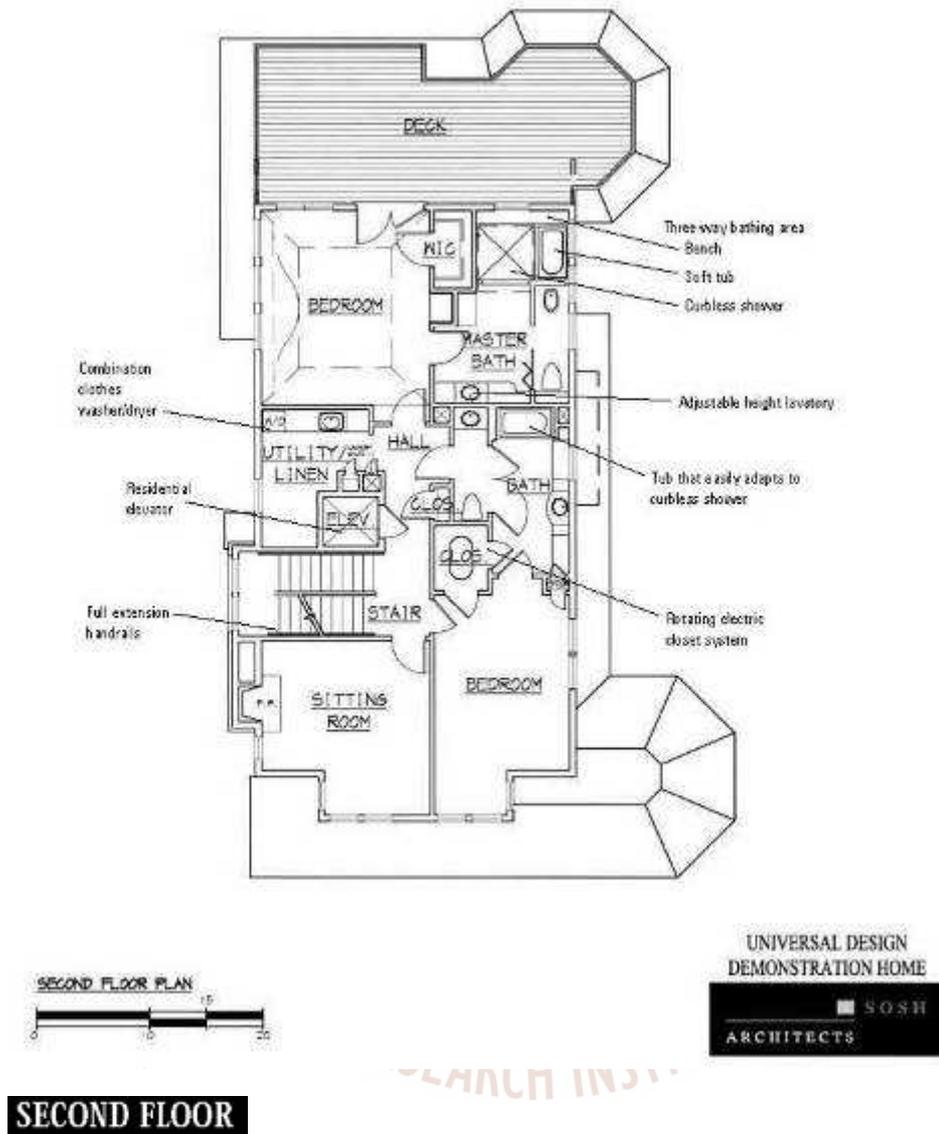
New Jersey 州展示住宅新建案例 二層平面圖
